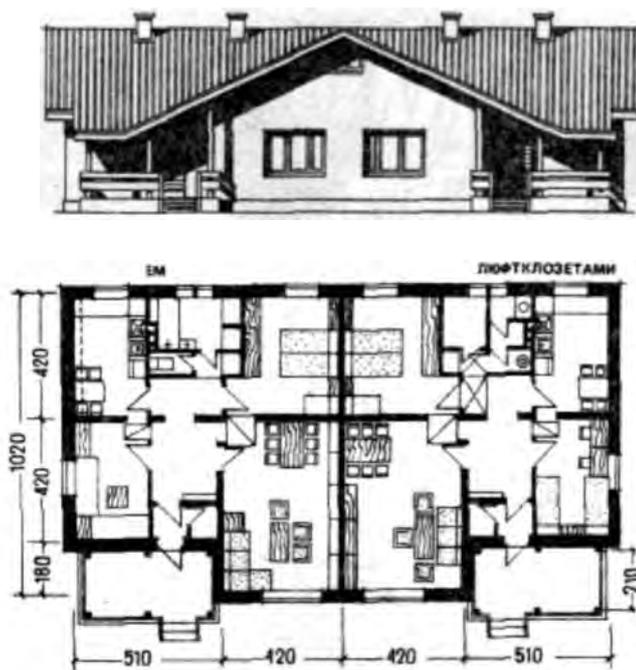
Двухквартирный одноэтажный дом с вариантами инженерного оборудования. Фасад, план этажа
